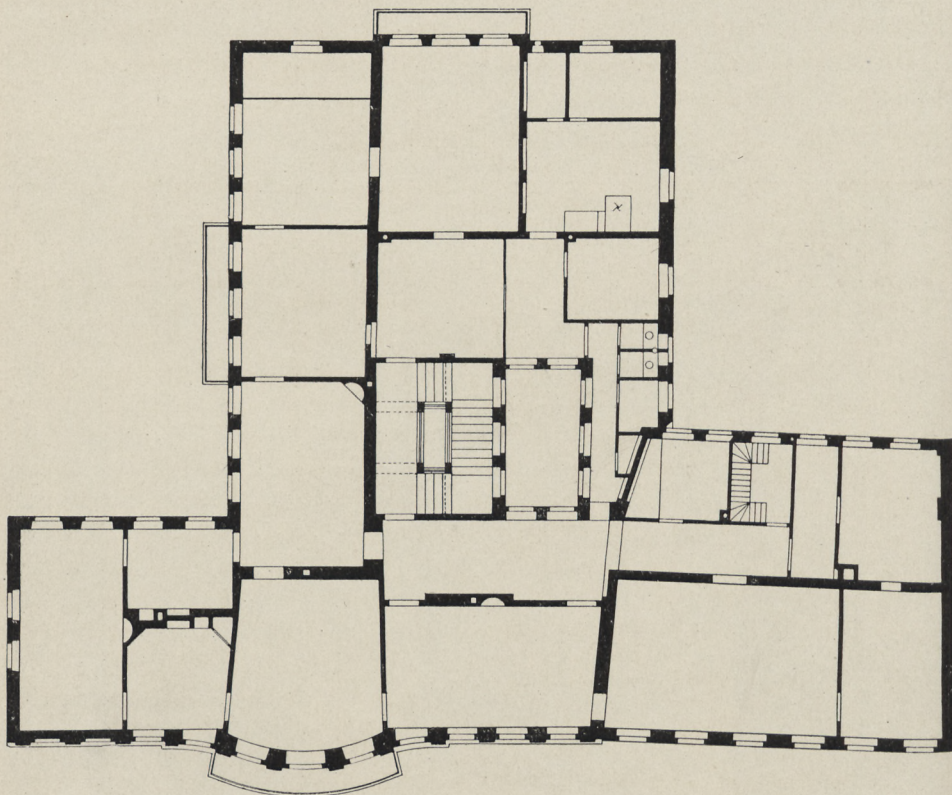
Boxberg'sches Palais, Grundriss des Obergeschosses.
